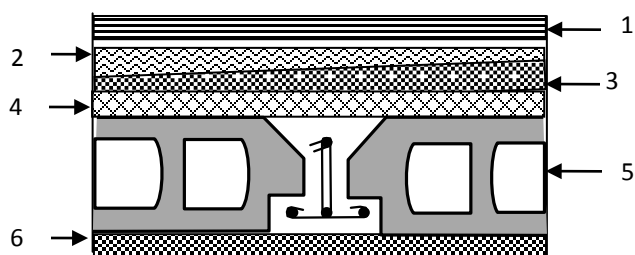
Coupe transversale dans le plancher terrasse inaccessible.
